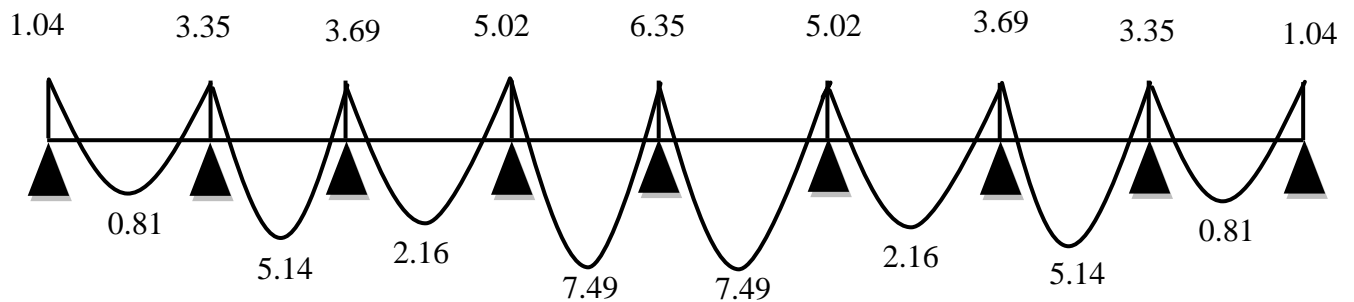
Schéma statique de poutrelle plancher étage (type2).
